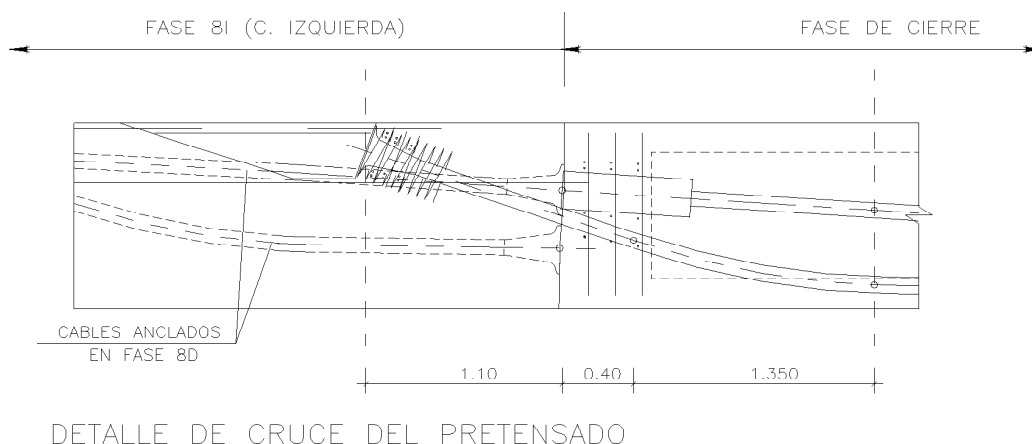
Detalle de cruce del pretensado en la última fase del tablero.
